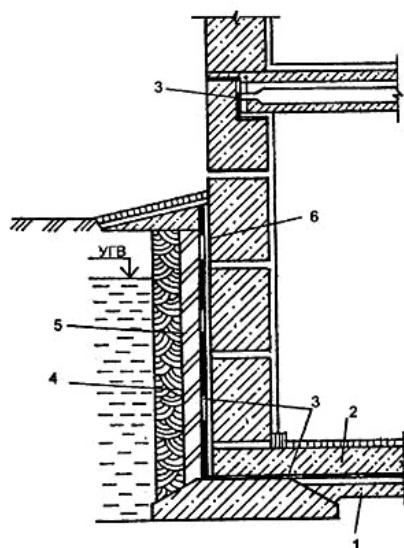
Гидроизоляция ленточного фундамента в здании с подвалом: 1 – бетонная подготовка; 2 – железобетонная плита; 3 – рулонная гидроизоляция; 4 – мятая жирная глина 250 мм; 5 – кладка из кирпича-железняка на цементном растворе 120 мм; 6 – двойной слой битума
